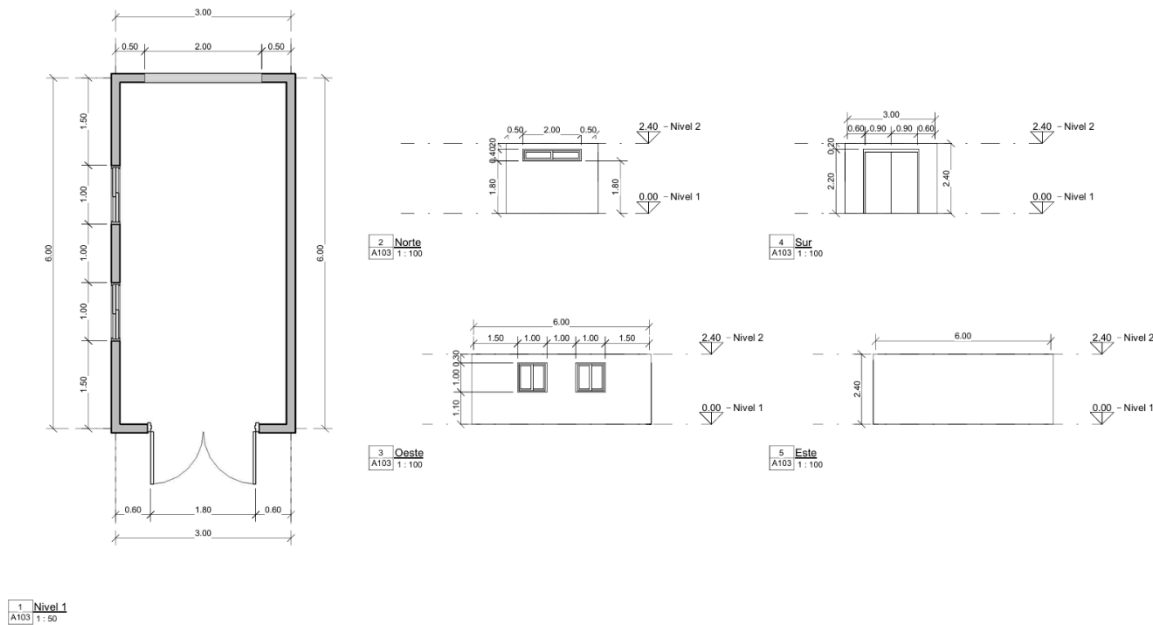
Planimetría utilizada para la ejecución de obra (Elaboración propia, Revit, 2025).
